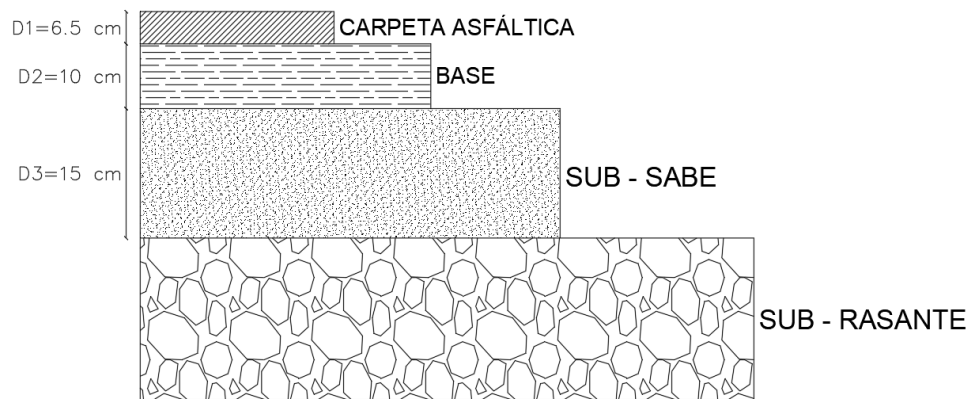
Diseño de la estructura del pavimento con CBR de laboratorio
